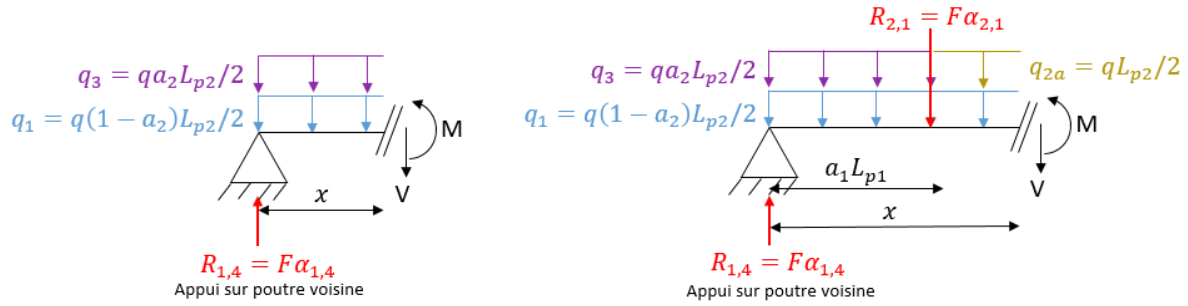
Poutre type 1 – coupe 1 (gauche) et coupe 2 (droite)
